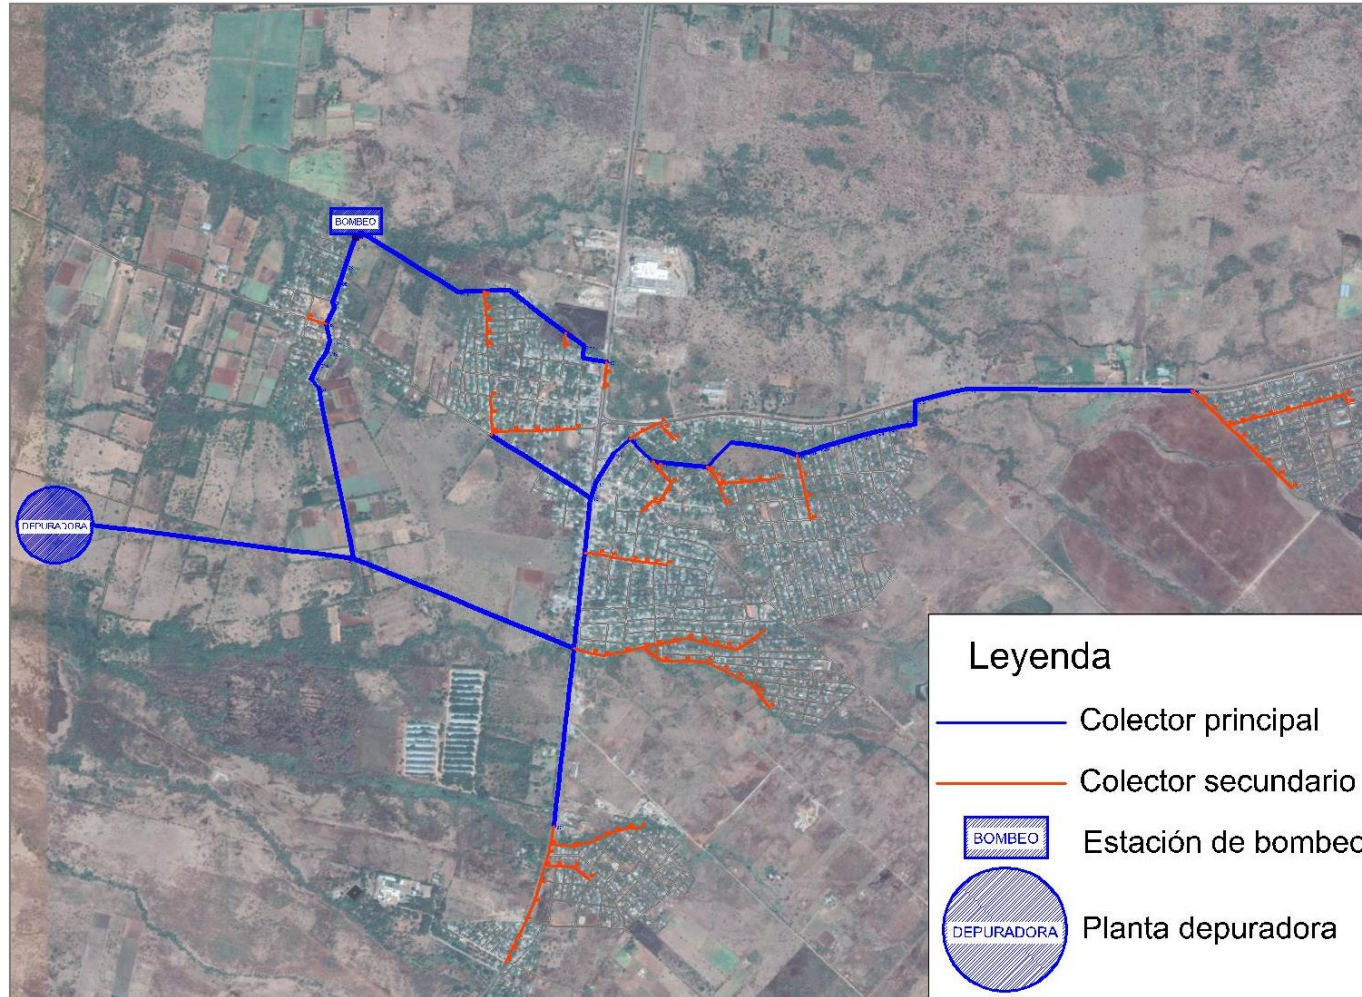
Trazado en planta de la primera alternativa para la red de saneamiento. Fuente: Elaboración propia.
